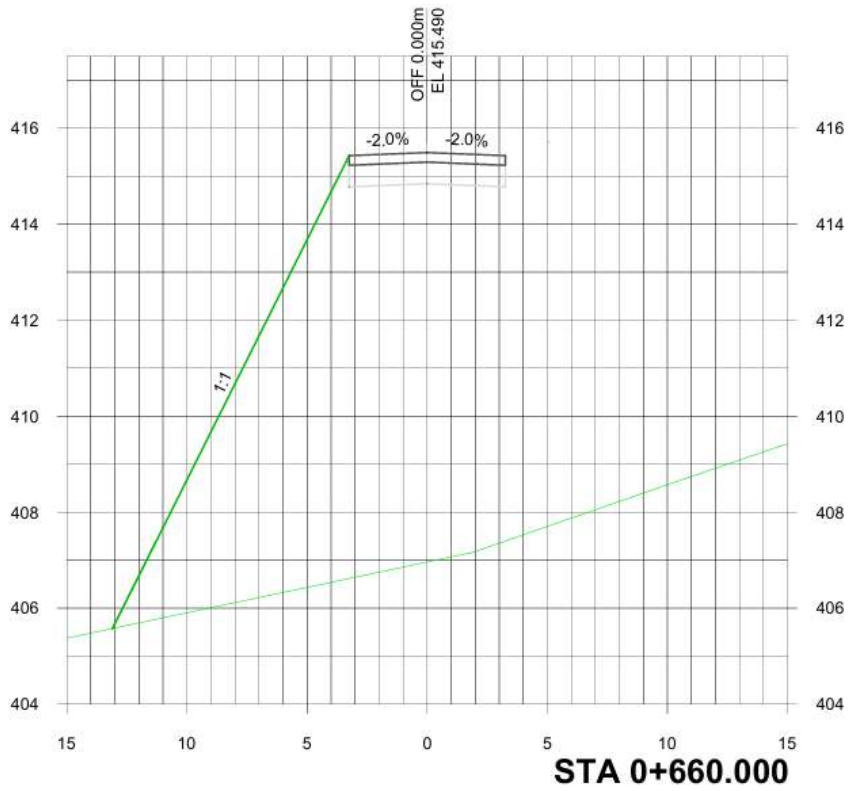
Perfil transversal EJE 12: STA 0 + 660,000
